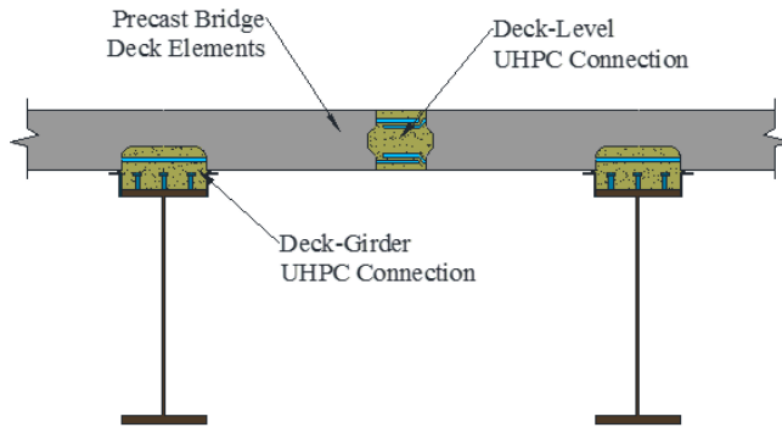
Ligações realizadas com UHPFRC entre elementos de plataforma da ponte pré-fabricados e vigas de suporte [28].
